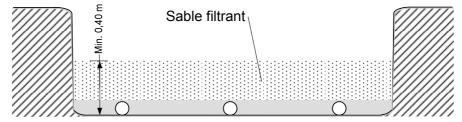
Vue en coupe du bassin avec la couche de sable filtrant
